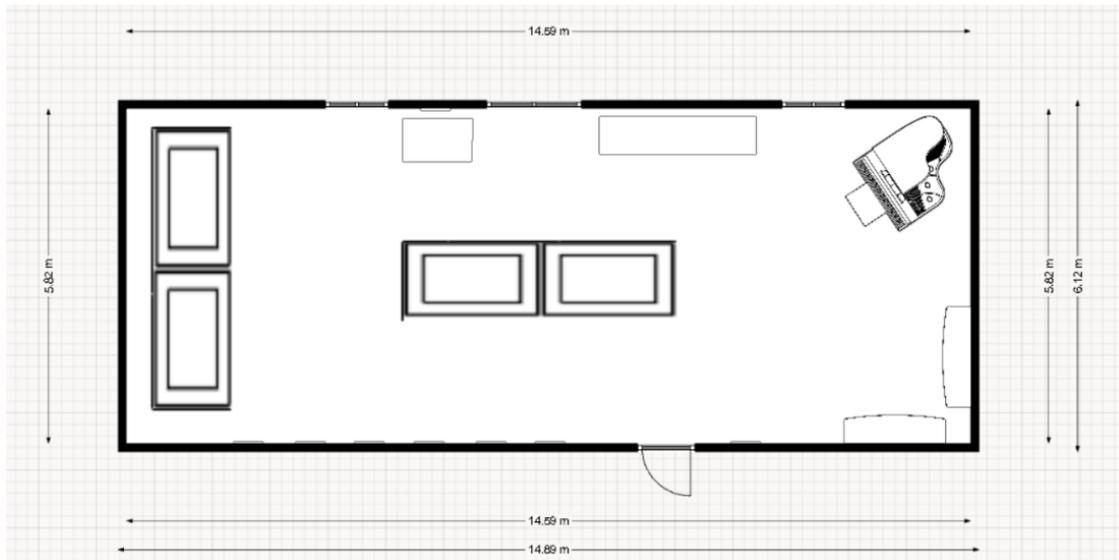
Figura IX: Plano elaborado por la autora de la Sala Museo con la nueva propuesta de disposición.
